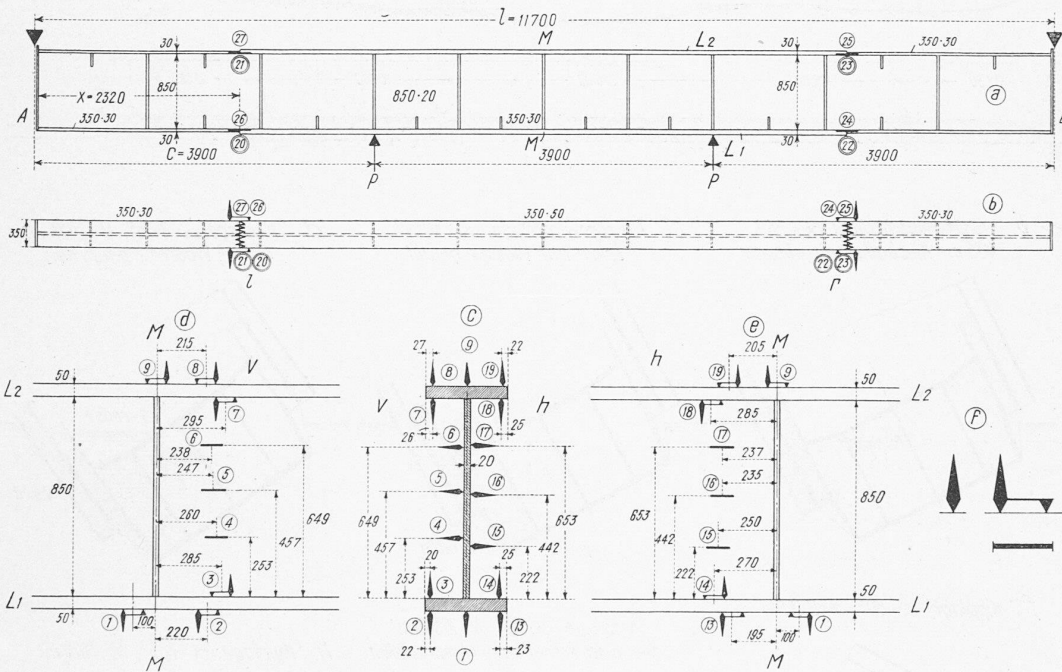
Ansicht und Draufsicht des Trägers 1 : 80 und Querschnitte 1 : 30, mit Angabe der Messstellen.
